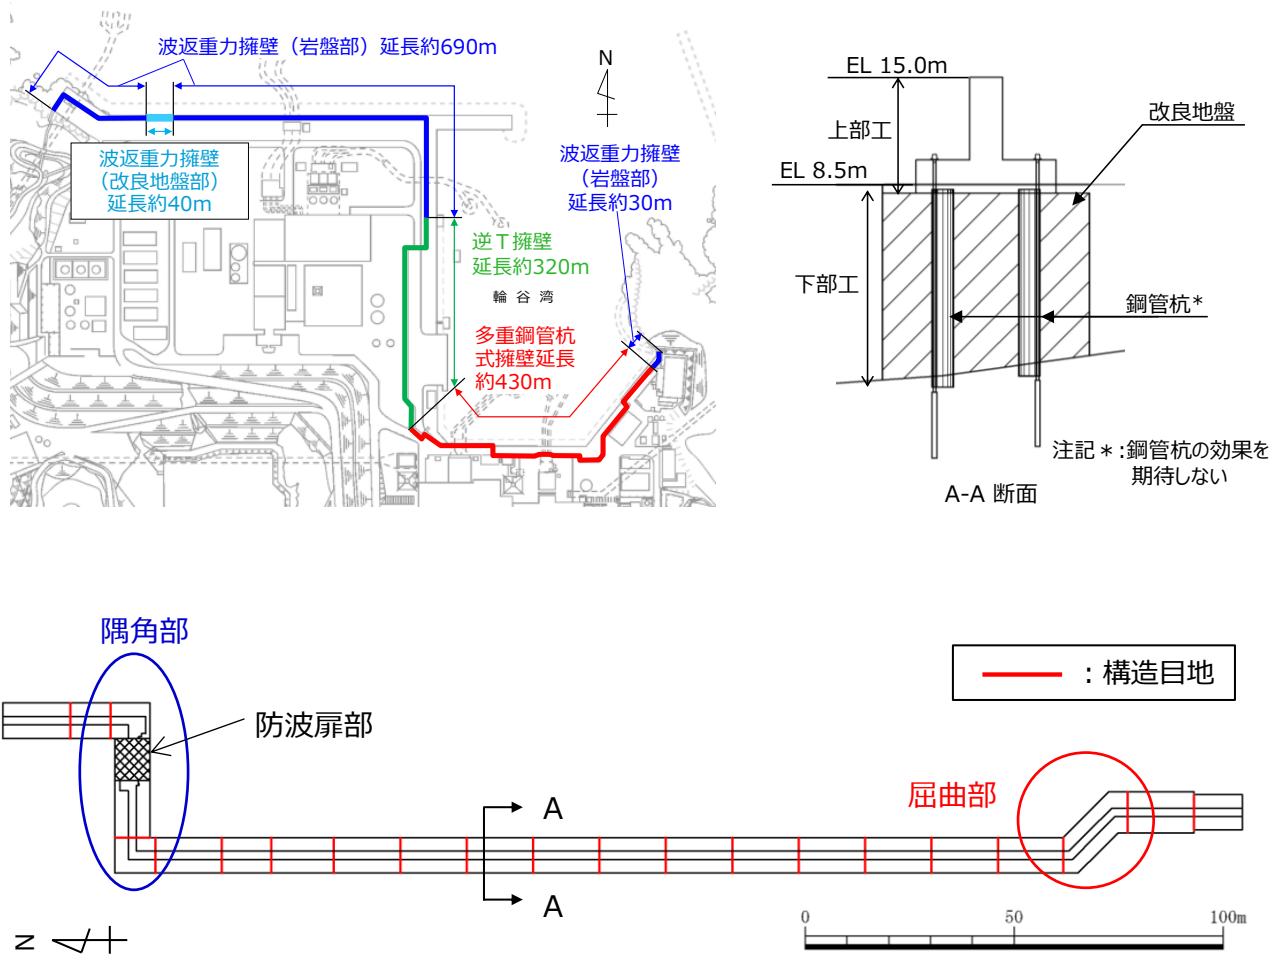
防波壁（逆T擁壁）の構造目地（平面図）
